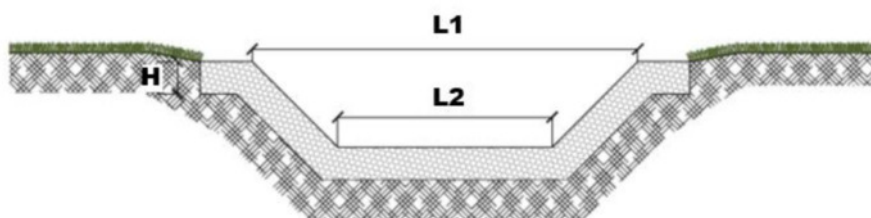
Sezione tipo del canale trapezoidale da realizzare lungo il layout
